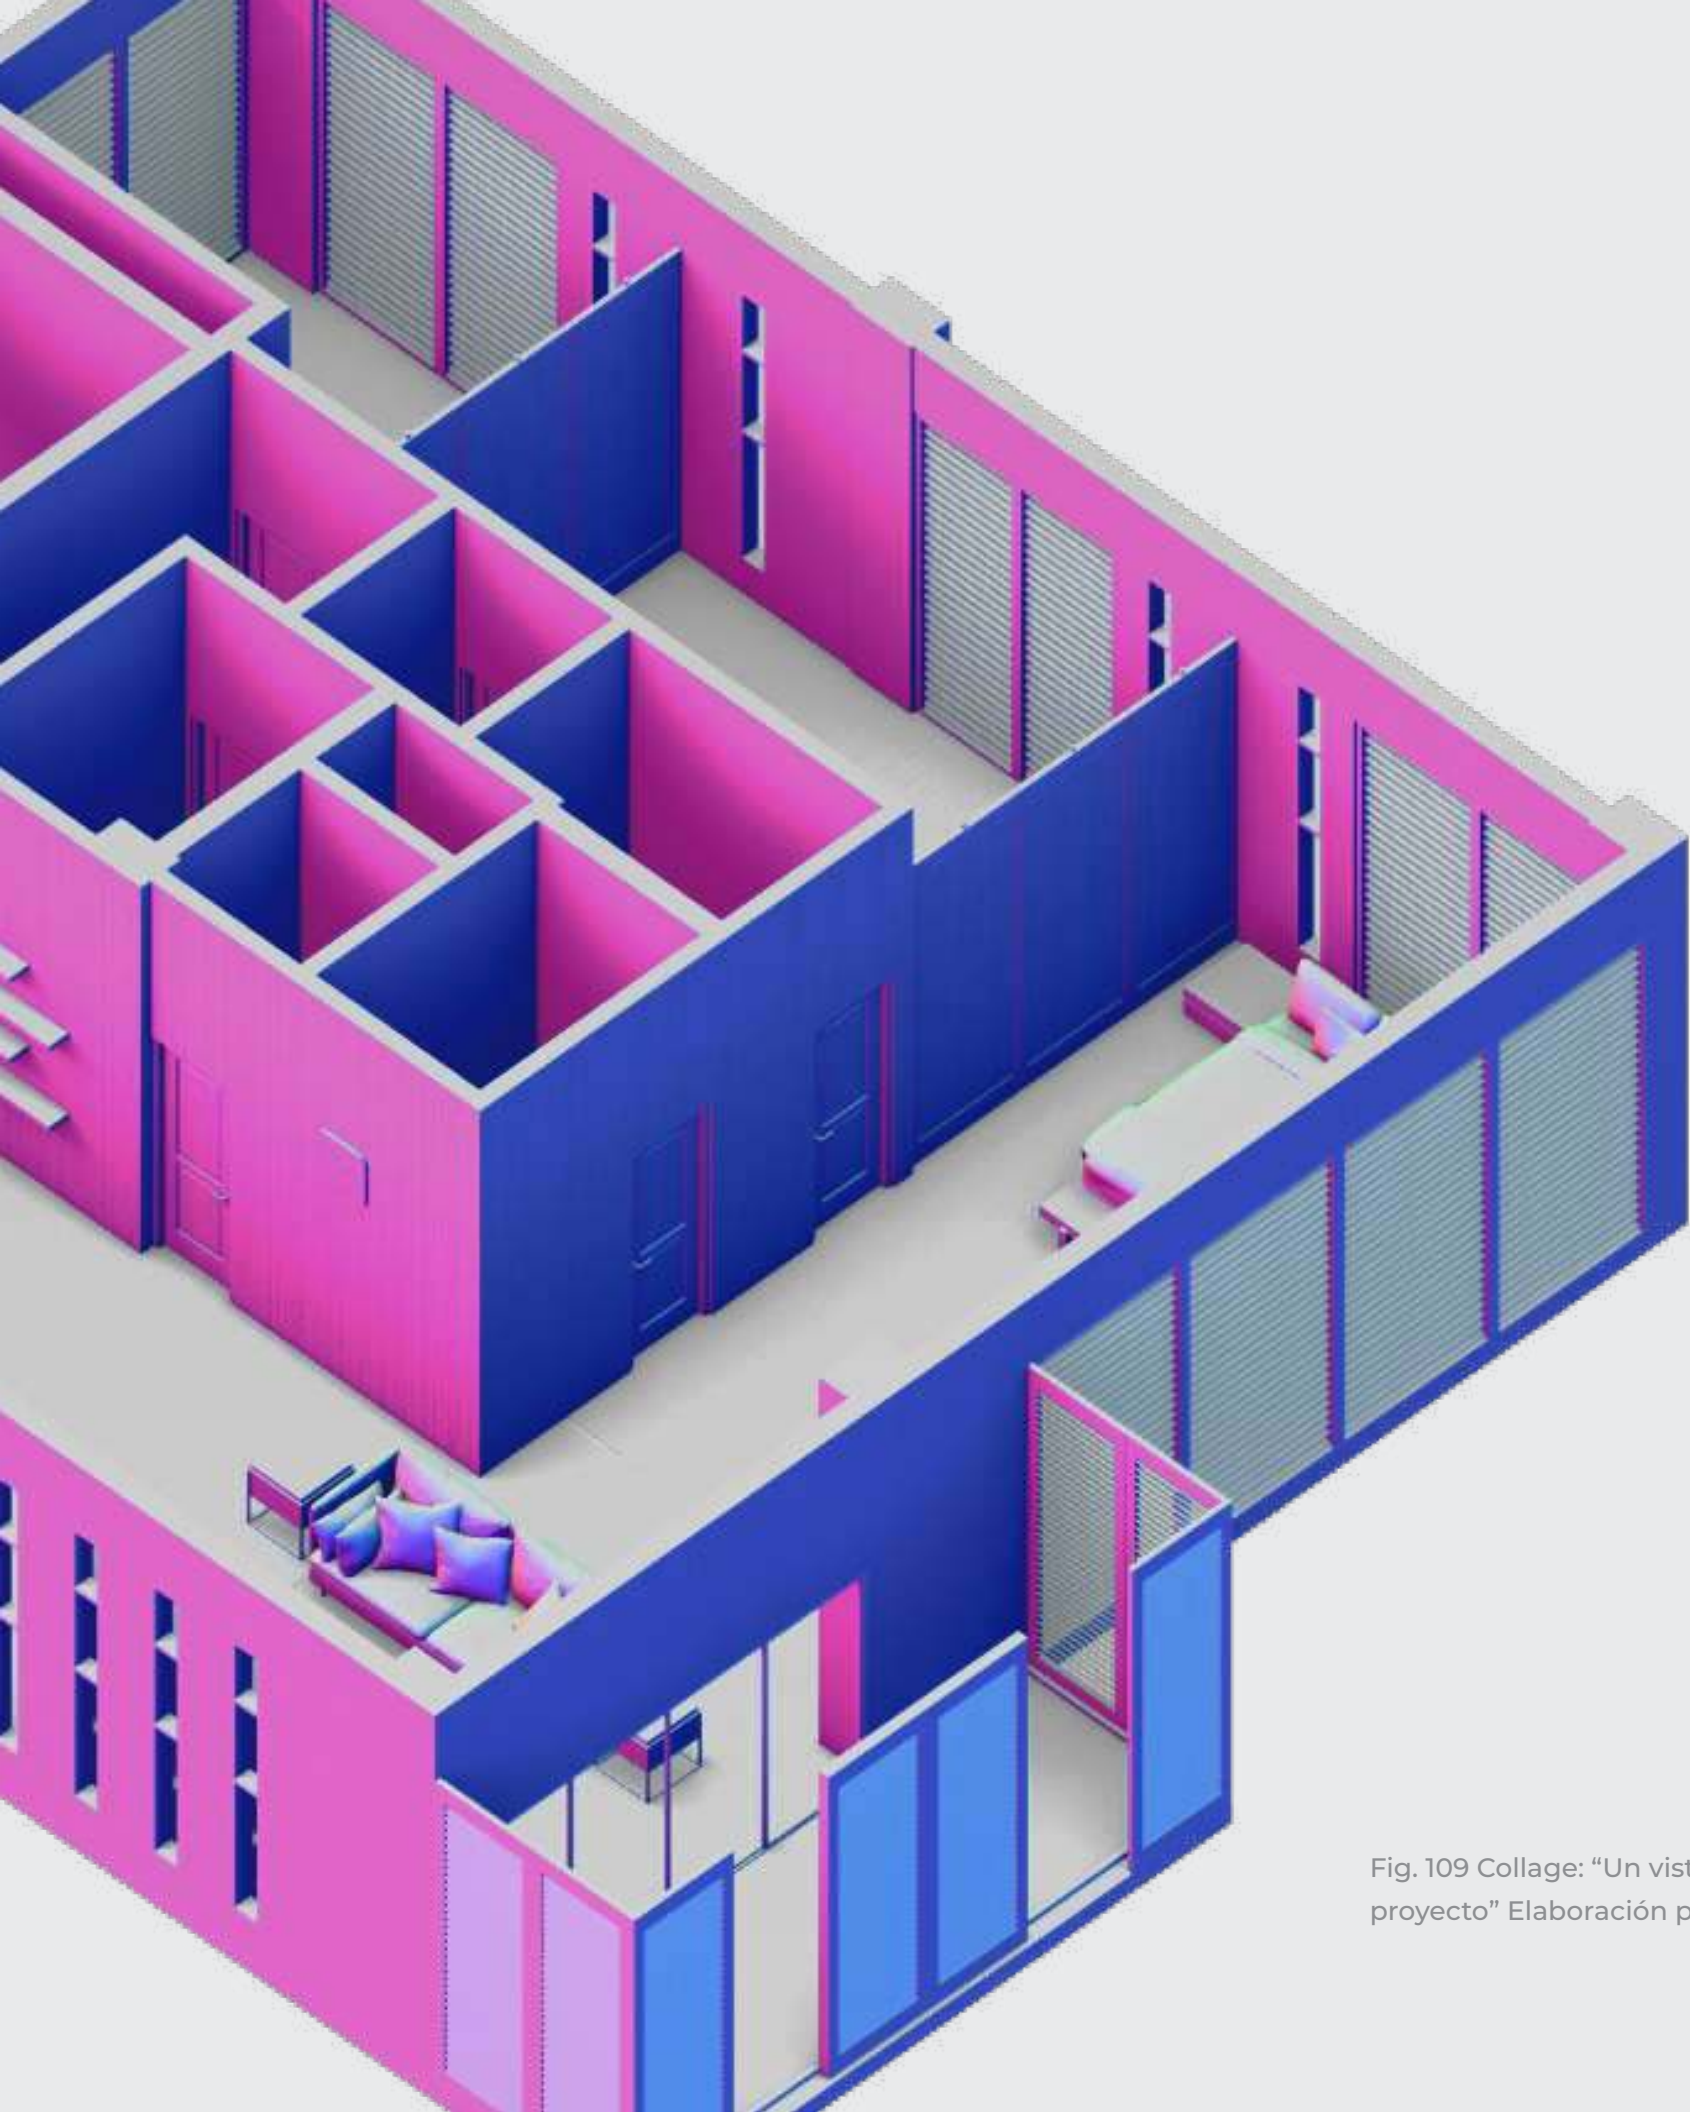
Collage: "Un vistazo por el proyecto" Elaboración propia.
